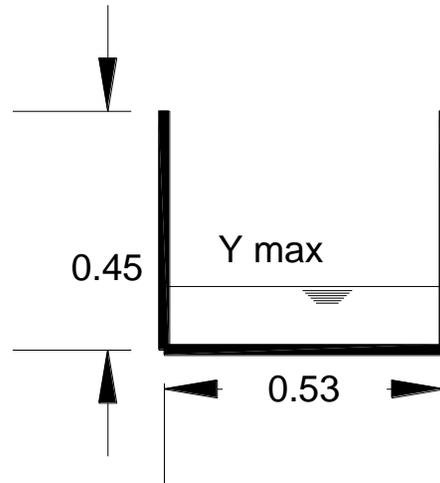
Vista del canal de distribución hacia los reactores
